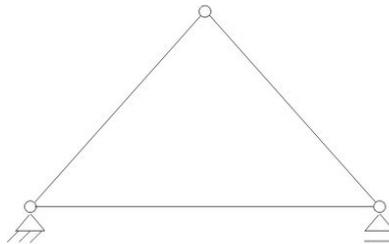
Das einfachste Fachwerk - ein aus Grundelementen bestehendes Fachwerk ist innerlich unverschiebbar. Es ist stabil.
